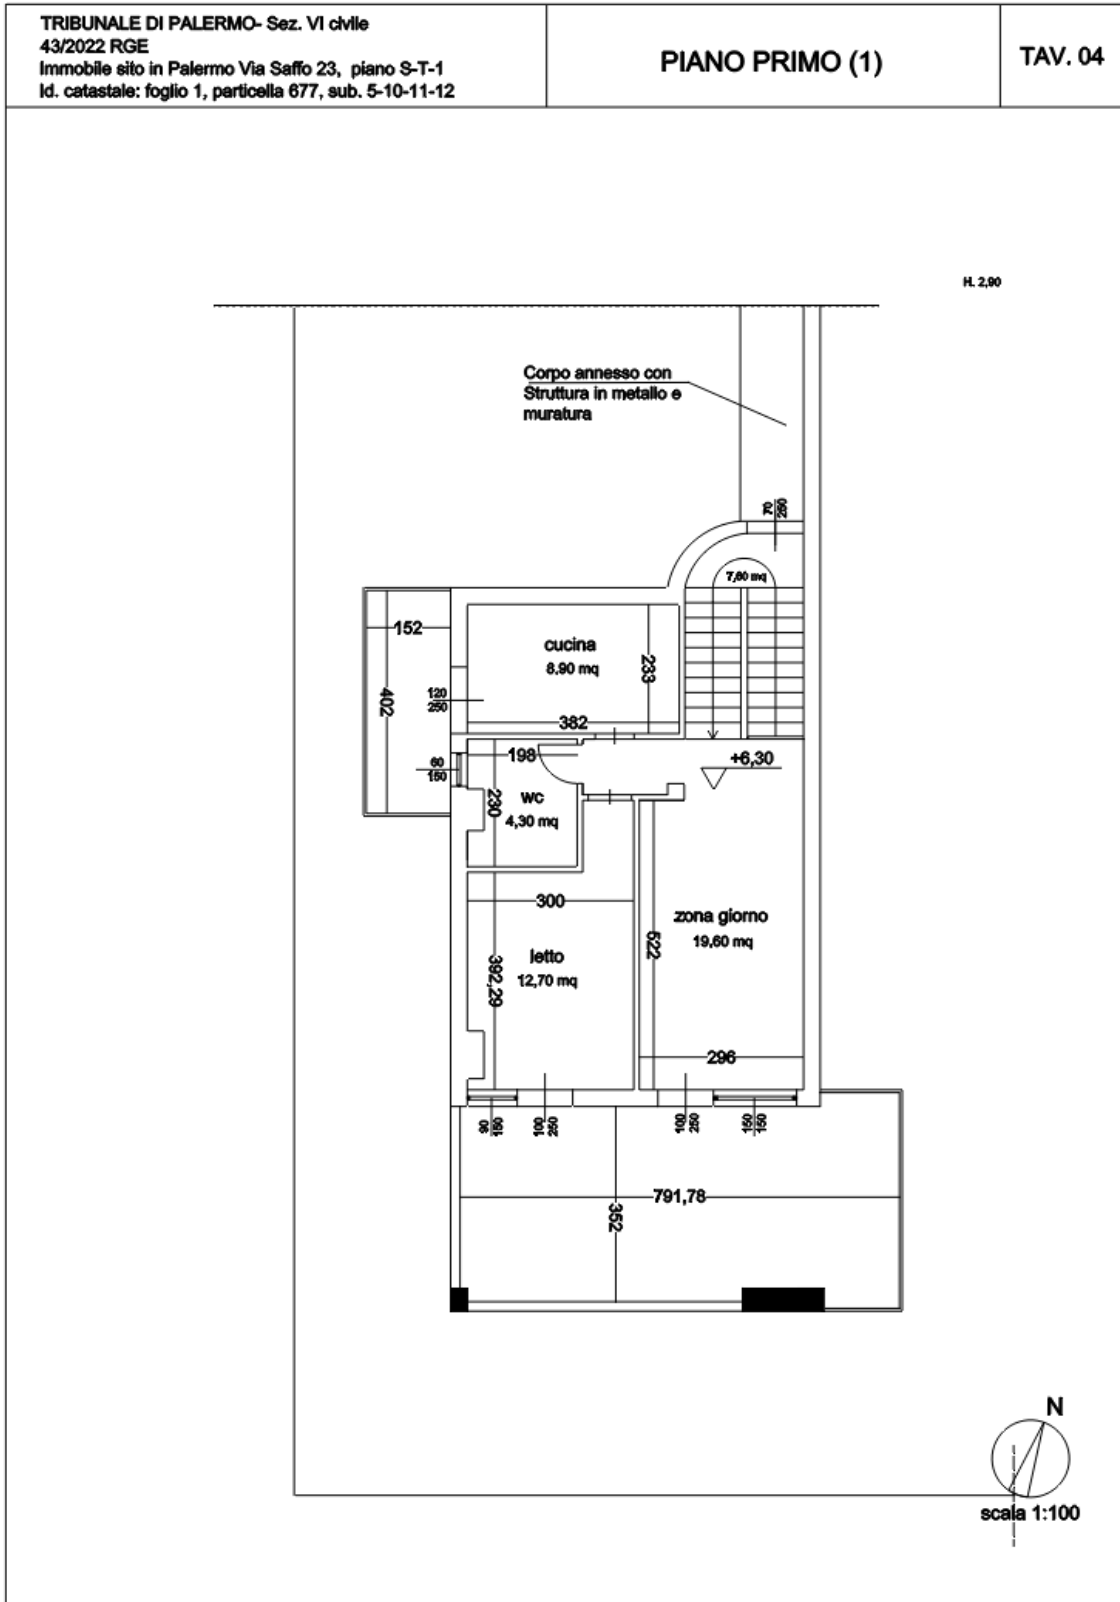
rilievo del 20/07-12/09-31/10/2023 planimetria PIANO PRIMO
